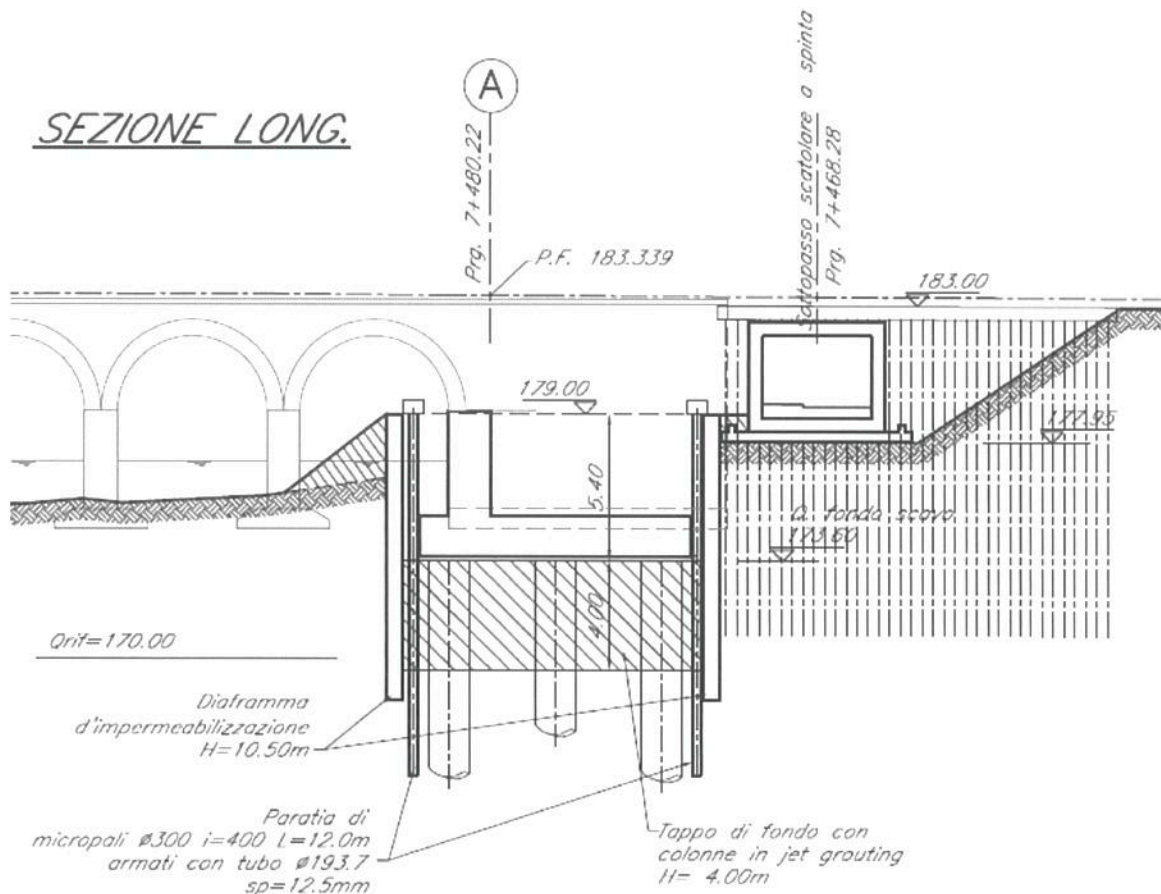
particolare delle opere di fondazione (elaborato MDL132D26BBVI0600001A)
